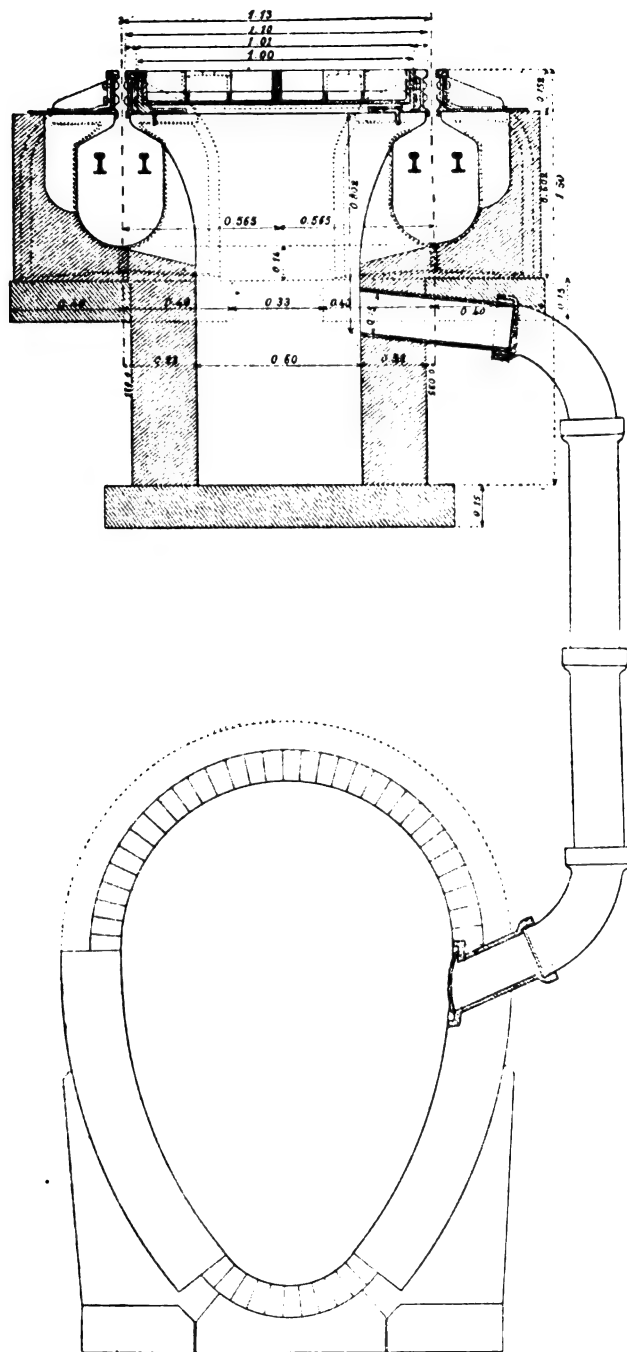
Coupe des caniveaux et coupe d'un regard de visite avec raccord à l'égout.
